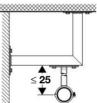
Pour des distances plus importantes de points fixes, du mur ou de la dalle, la pose de consoles de fixation est recommandée.
